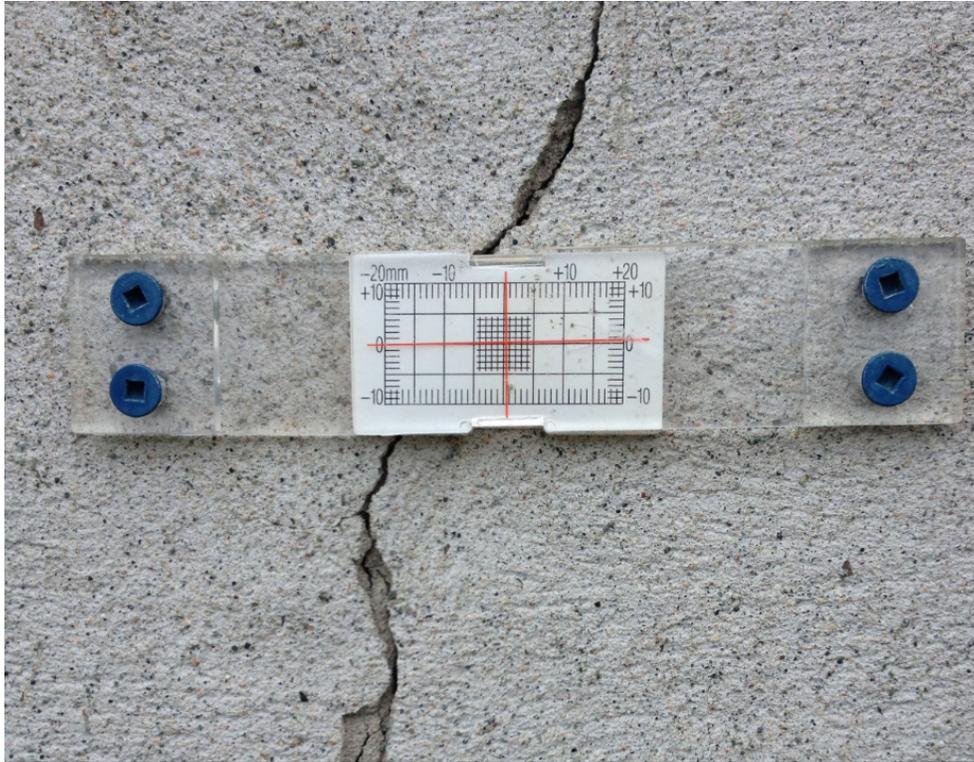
Fissuromètre installé sur le mur d'un bâtiment dans la Ville de Malartic
